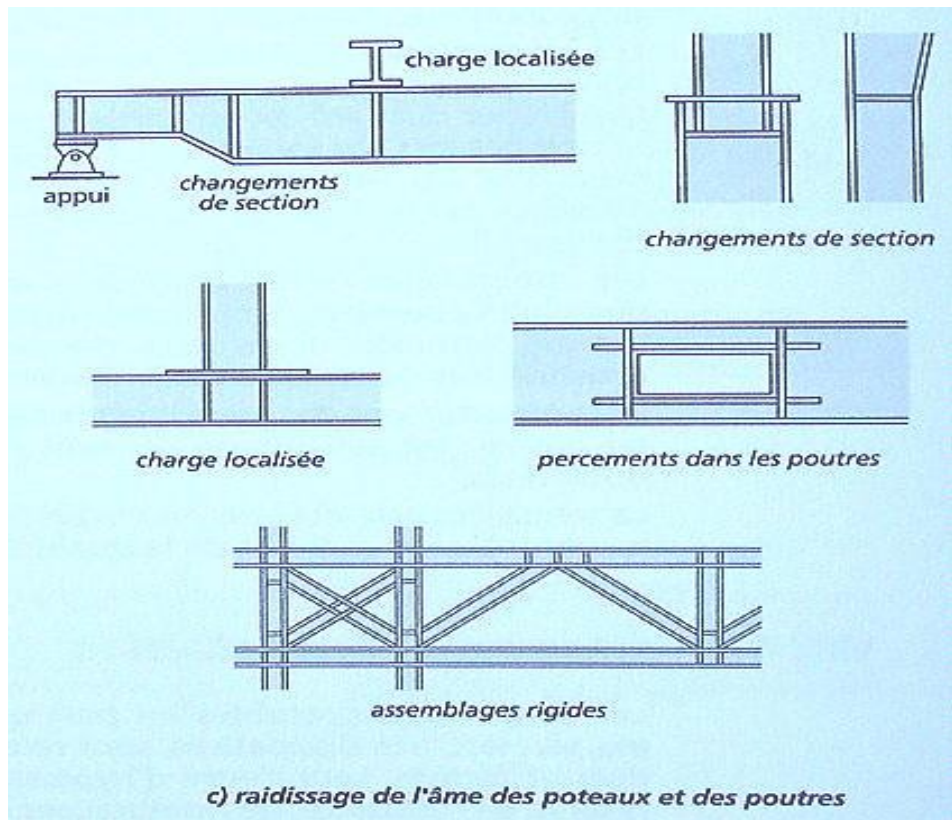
Exemple de raidissage par entretoises des zones les plus sollicitées des sections pour éviter leur instabilité latérale.
